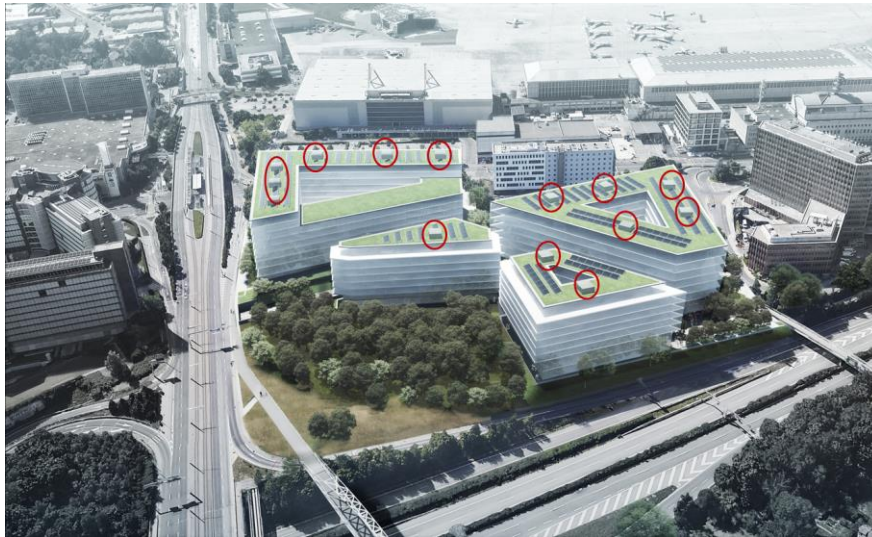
Installation techniques en toiture qui ne doivent pas dépasser le plafond aérien.
